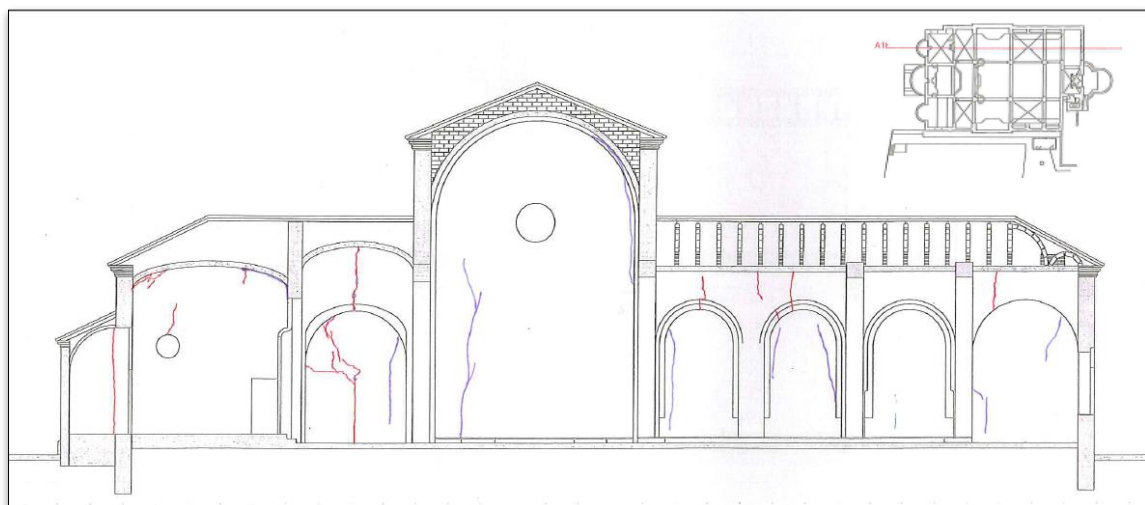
Grietas sección longitudinal ala este (plano PAT. 04)
